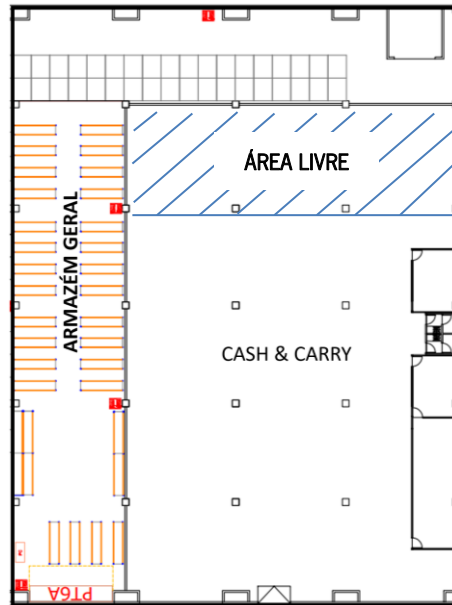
Planta do armazém geral com área livre do Cash & Carry.
